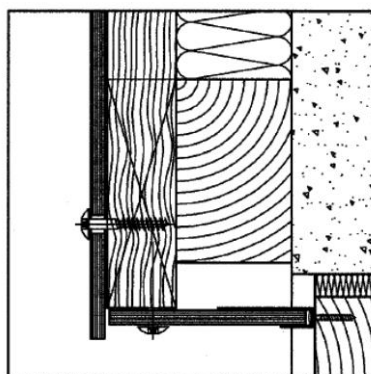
Joint vertical (vue en coupe horizontale)
